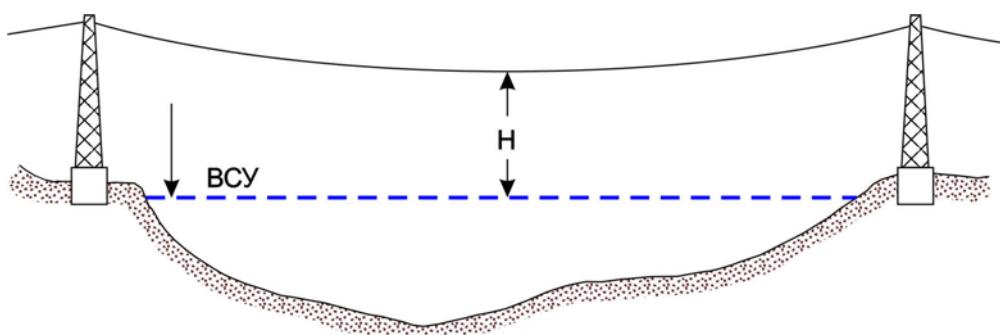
Принципиальная схема кабеля, натянутого над рекой
